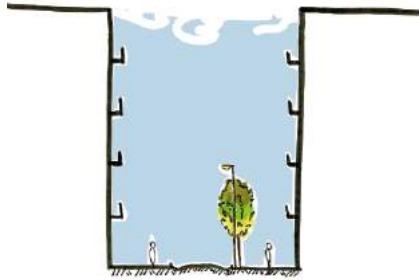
Esquema plano de aire calle Foc Follet (lado norte)
